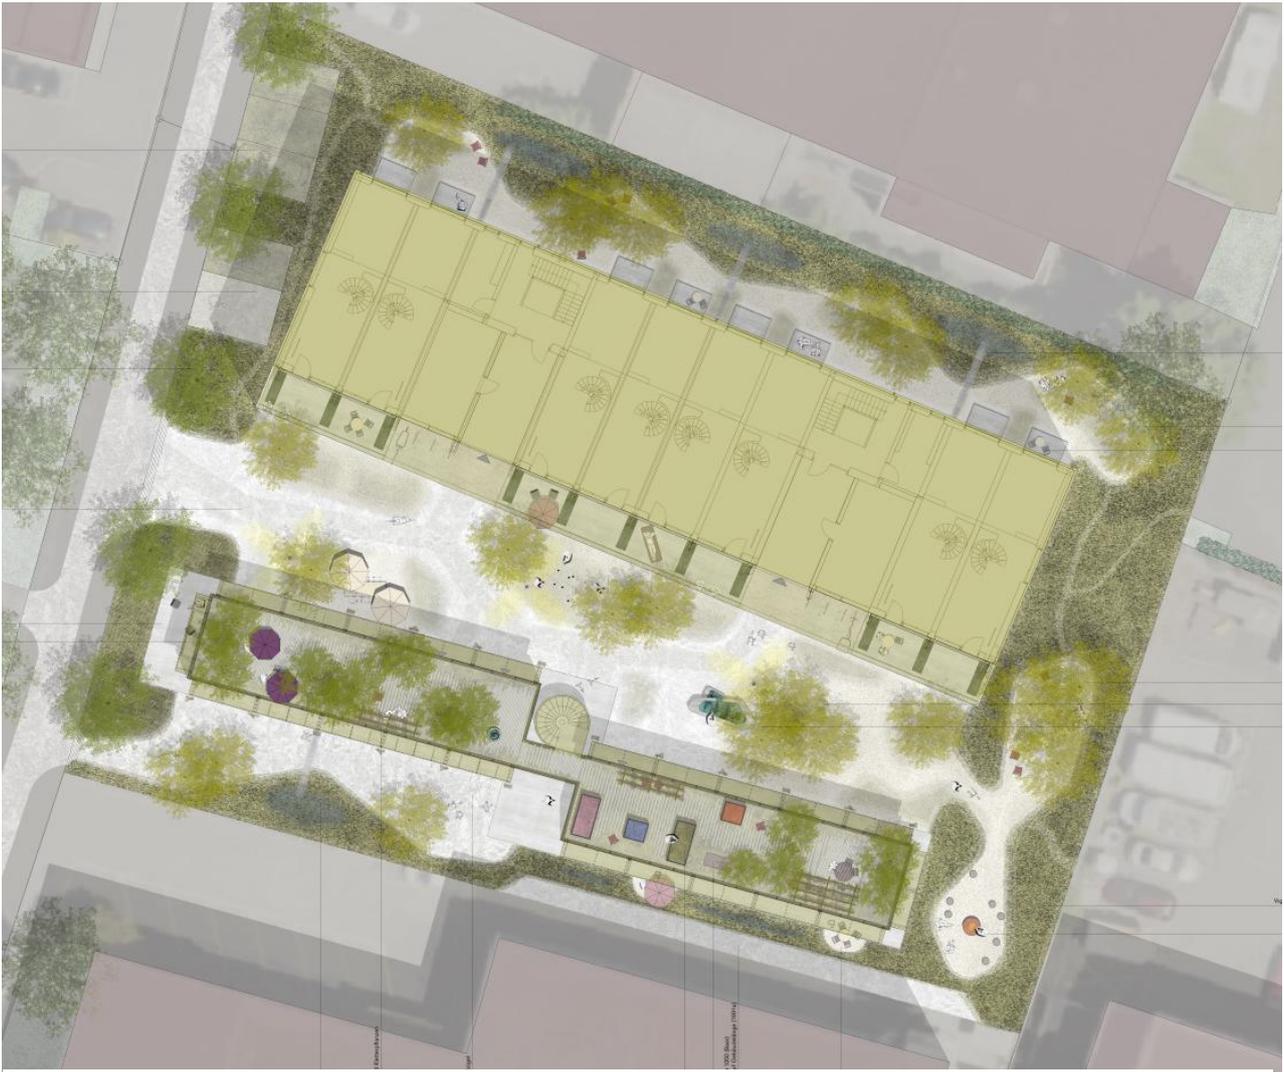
Plan Aussenraum (Planstand 10.06.2024)
